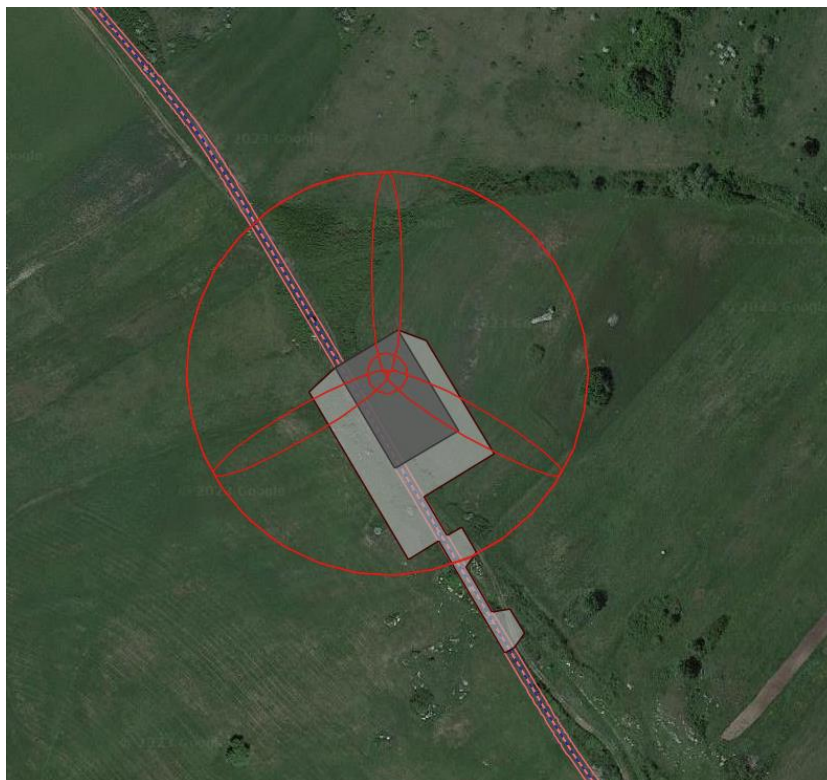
schema piazzole (grigi=aree temporanee di cantiere; grigio scuro=area fase di esercizio)
